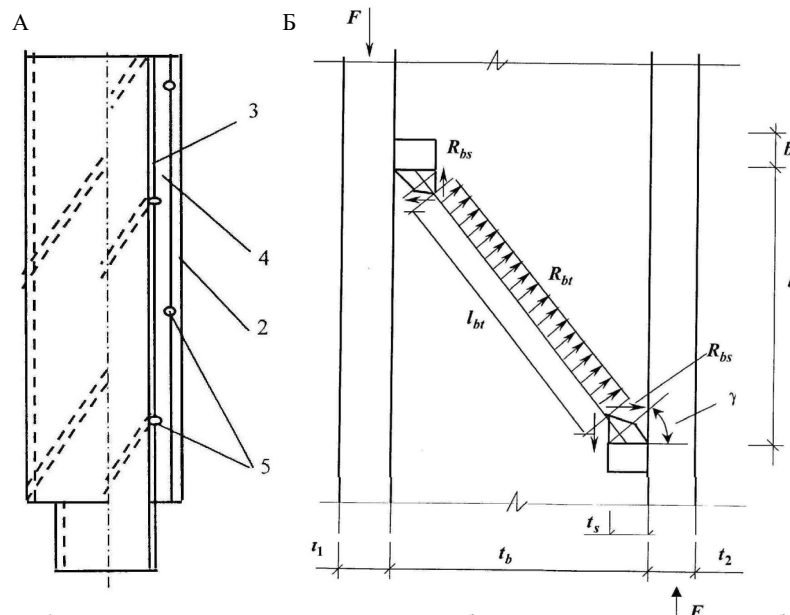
А - Узел закрепления свай с ребрами на поверхностях труб, установленных под углом к продольной оси соединения. 1 - опорная стойка МССП; 2 - направляющие «юбочных» свай; 3-«юбочная» свая; 4 - бетонное заполнение; 5 - ребра на поверхностях труб в зоне контакта с бетонным заполнением.
